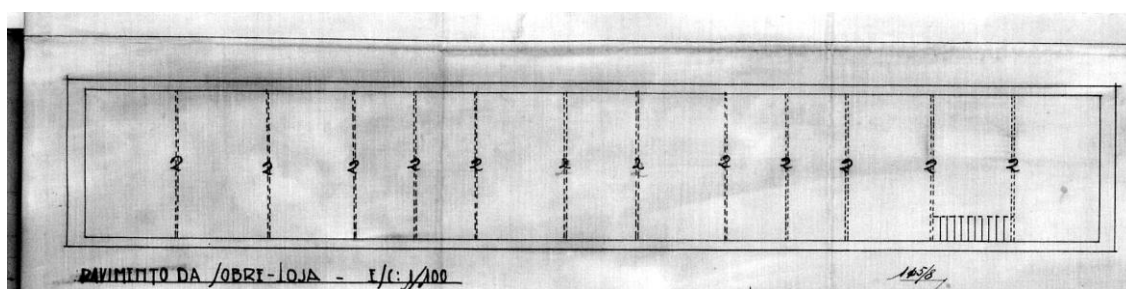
Pormenor construtivo do pavimento do piso 1 [6]
